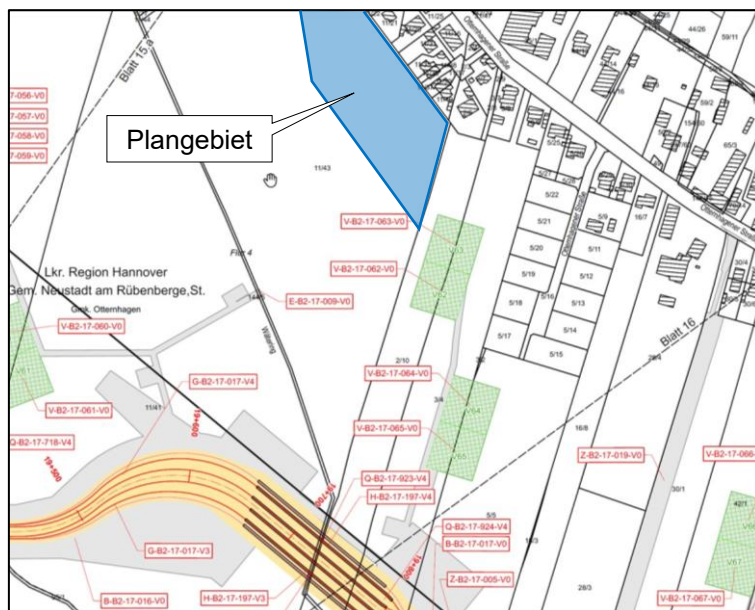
Plangebiet auf einem Ausschnitt aus den Planfeststellungsunterlagen des SuedLink (B2_C_06_Lageplan_AnI01_BI15_R01-gez.pdf, unmaßstäblich, nicht genordet)
